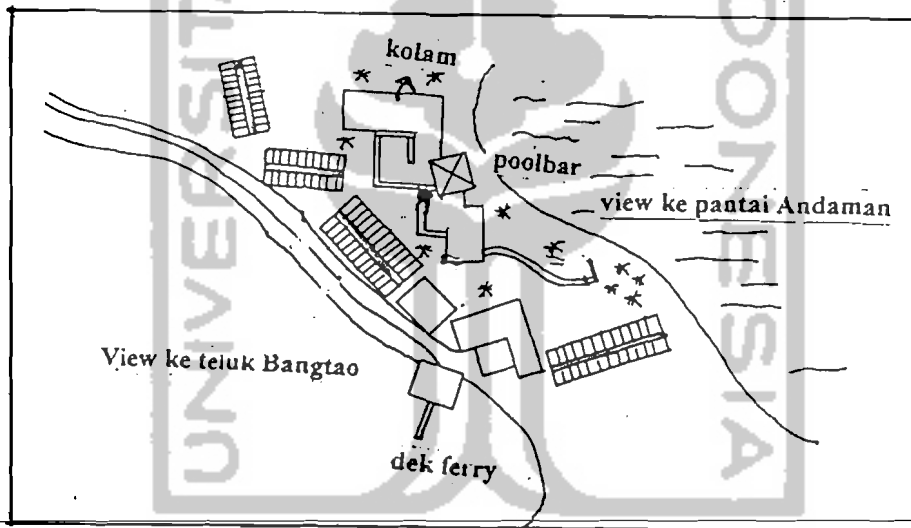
Site plan Laguna beach club, Phuket, Thailand
